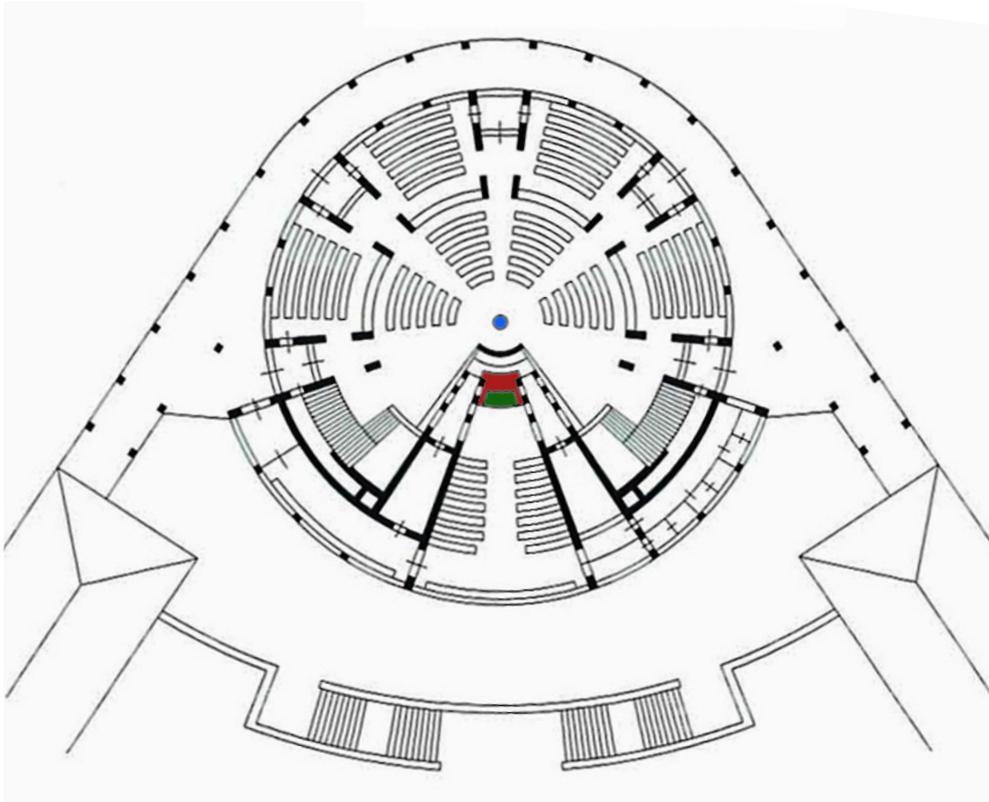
Grundriss mit eingezeichnetem Taufbecken (blau), Abendmahlstisch (Rot) und Kanzel (Grün)
